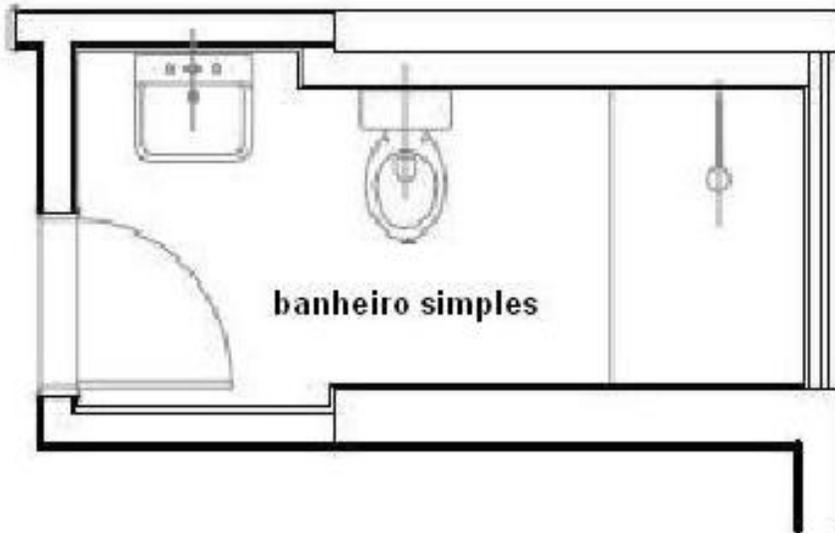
Planta Baixa de um banheiro simples.
